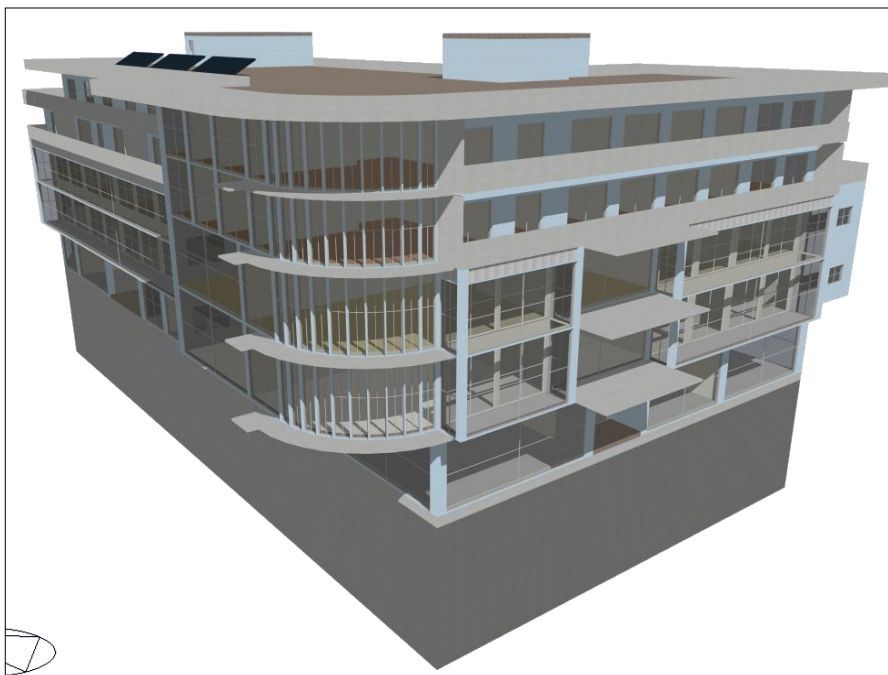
Render do modelo construído no Design Builder, da fachada Sul e Este do edifício
